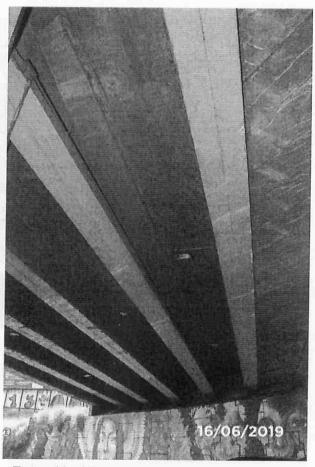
Vista da face inferior do tabuleiro, sentido centro. Vigas com desplacamento de concreto, infiltrações, armaduras expostas.
